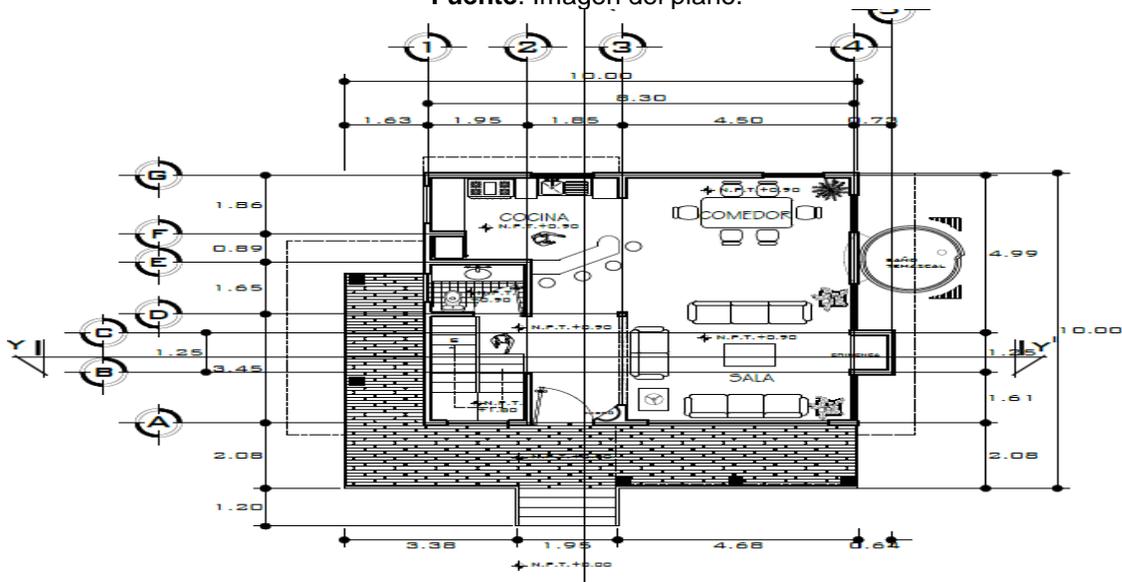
Plano arquitectónico de la cabaña con baño de temazcal.
